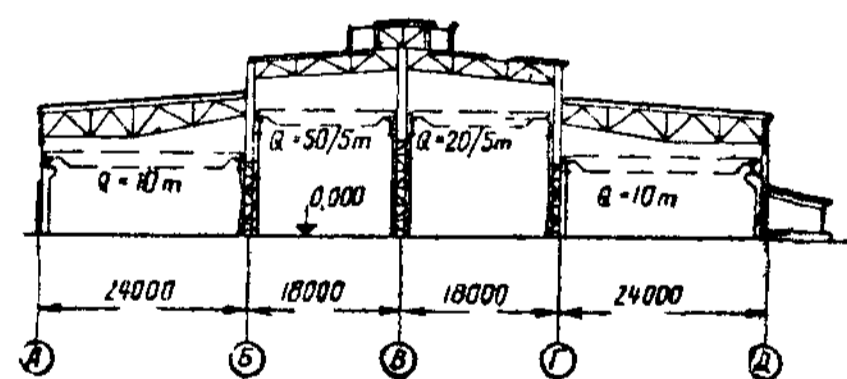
Перекрытие боковых пролетов фермами с переломом нижнего пояса в электросталеплавильном цехе
